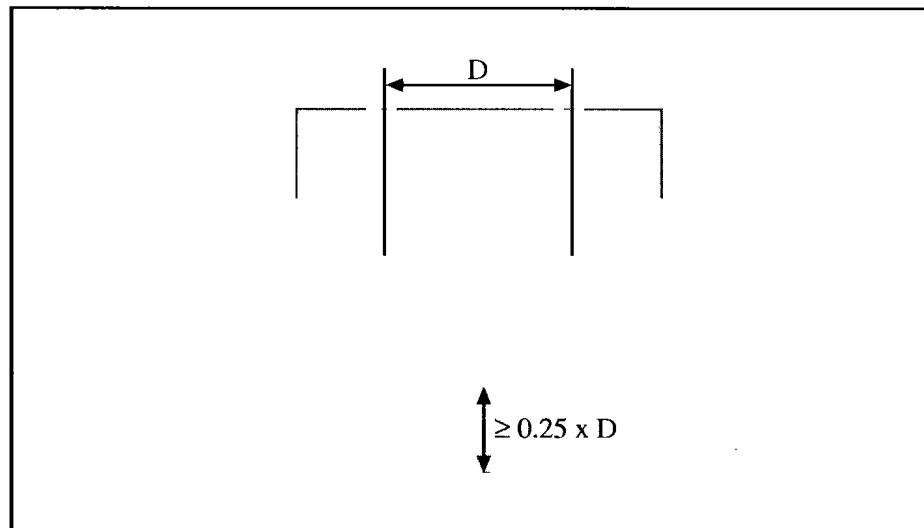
Принцип установки бетонных грузов для подводных трубопроводов.
